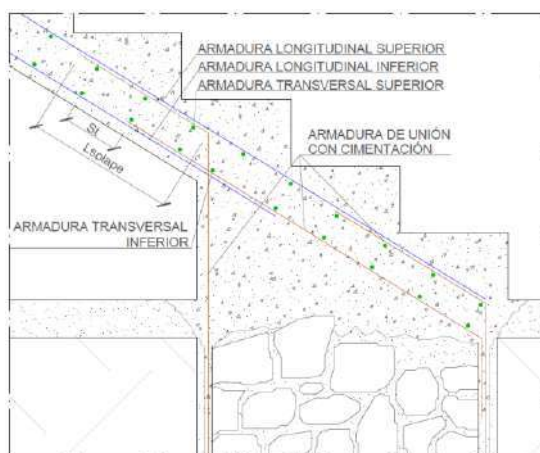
Detalle de unión de escalera con cimentación. 2016. Fuente Propia
